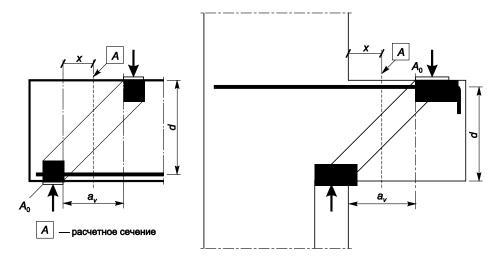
К расчету коротких балок и консолей, не имеющих поперечной арматуры
